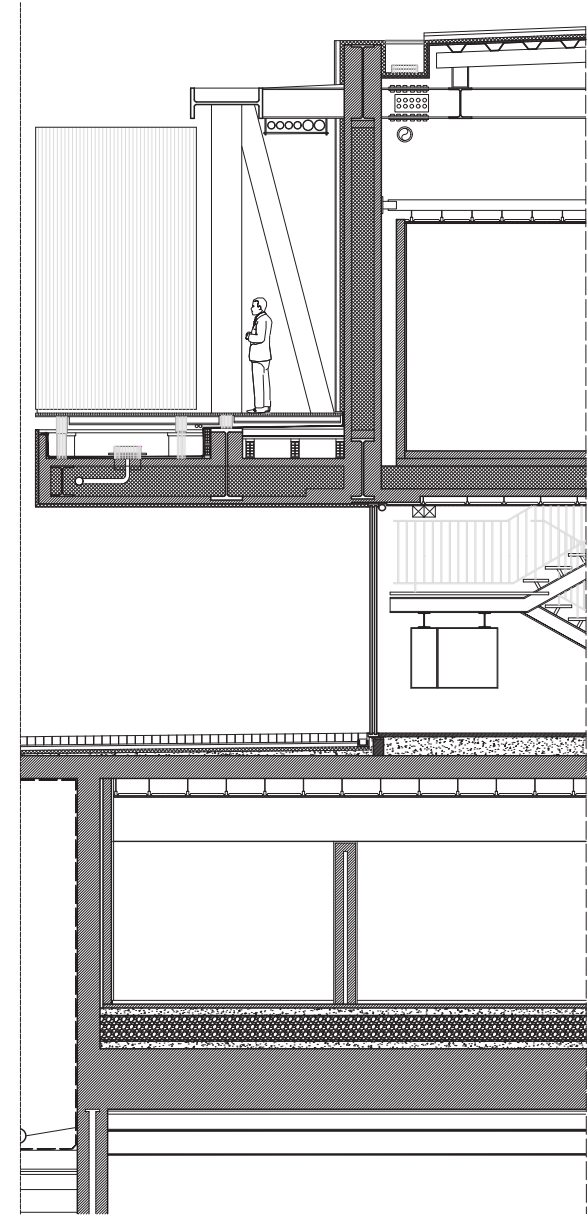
Sección construtiva por fachada. Escala 1/100.
